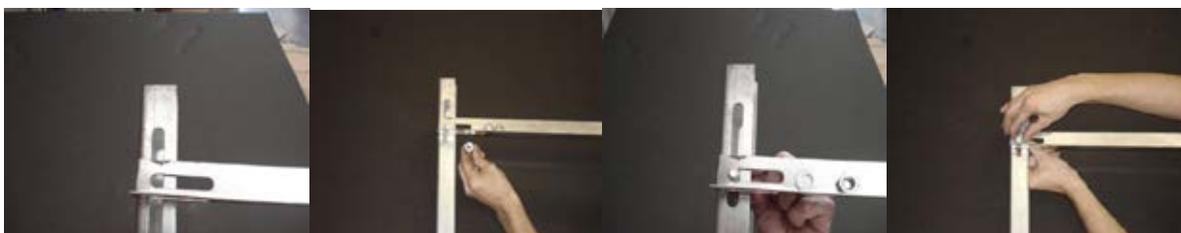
Montaje sobre cubierta plana (7) captadores plano
